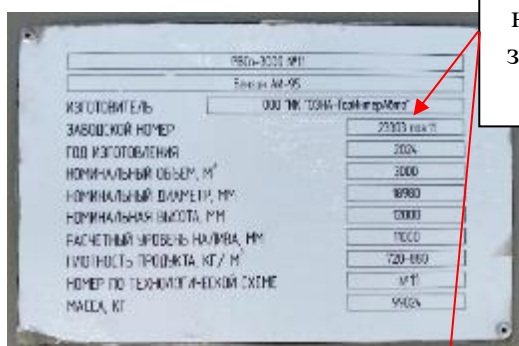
Маркировочная табличка резервуара РВСП-3000, заводской номер 23303 поз.11
